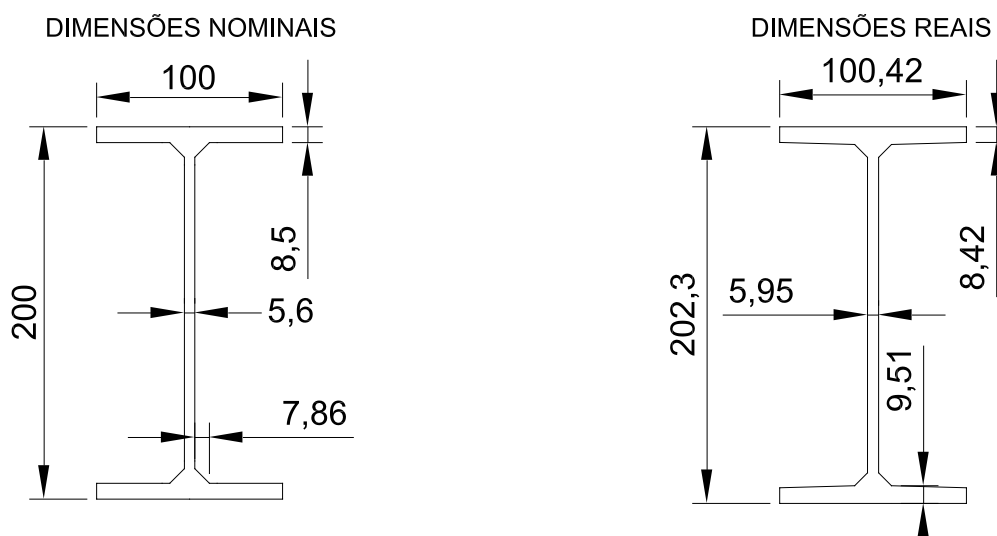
Dimensões nominais da seção transversal do perfil IPE 200 e dimensões reais deste elemento em uma das vigas mistas ensaiadas por Alves (2014).
